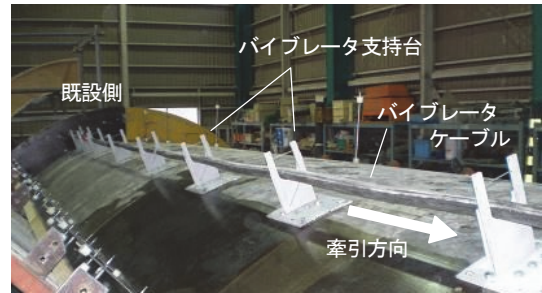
パイプレータ支持台およびパイプレータの設置状況 (模型実験 2)
